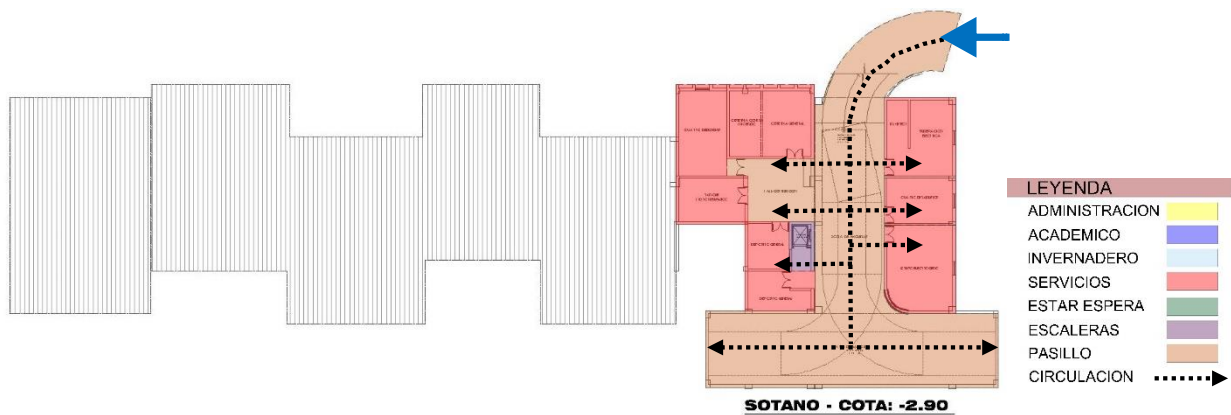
Proyecto – Planta Sótano – Cota -2.90
